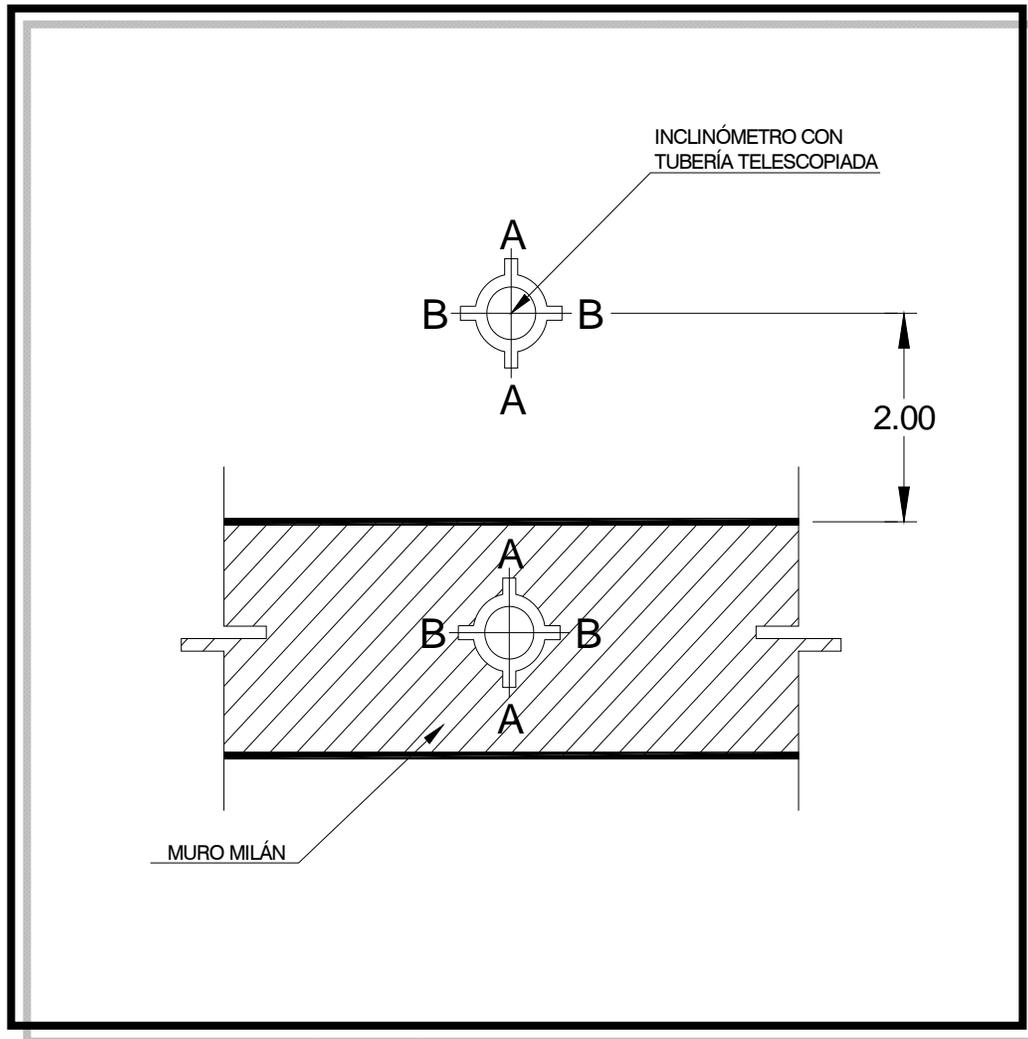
Instalación de tubería de pvc en armado de parrilla de muro milán
